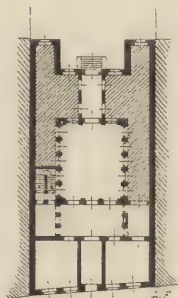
Palazzo Crispi zu Ferrara. Grundriss.
